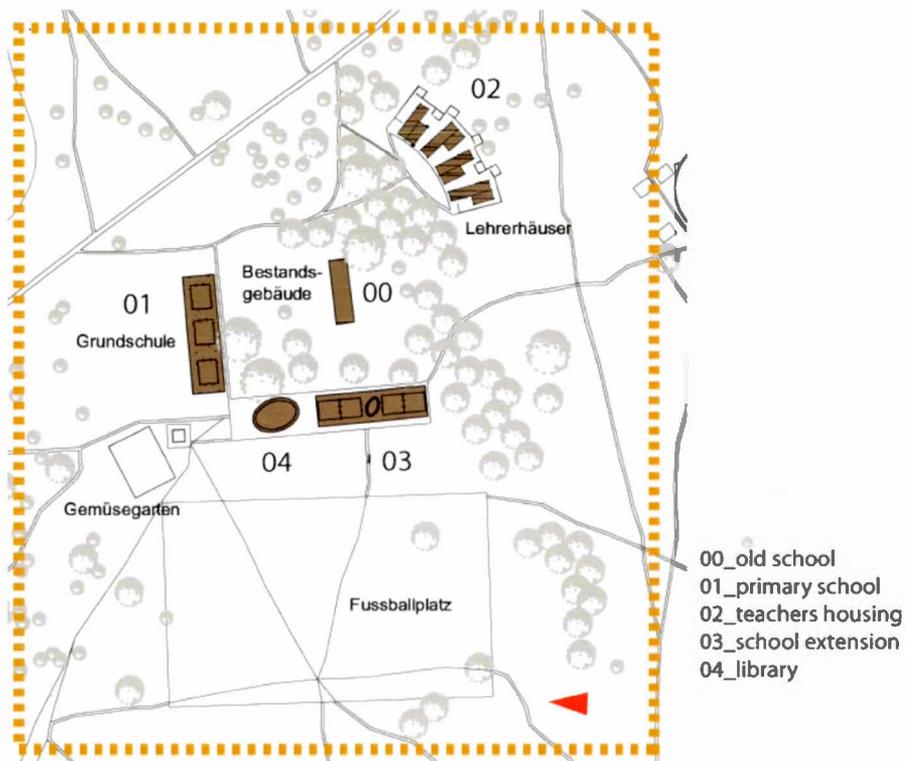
Plan du site scolaire annoté (Source : Fondation LaFarge-Holcim)
